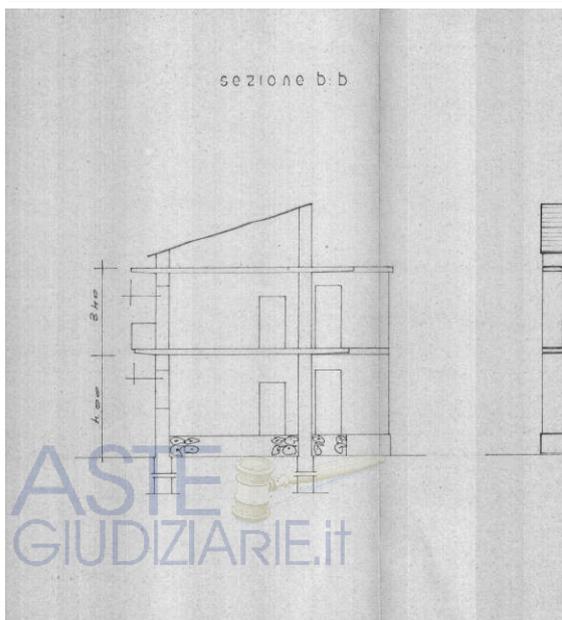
sezione urbanistica con deposito sottotetto al secondo piano secondo la L.E. n.4545/1977 del 21/04/1977
